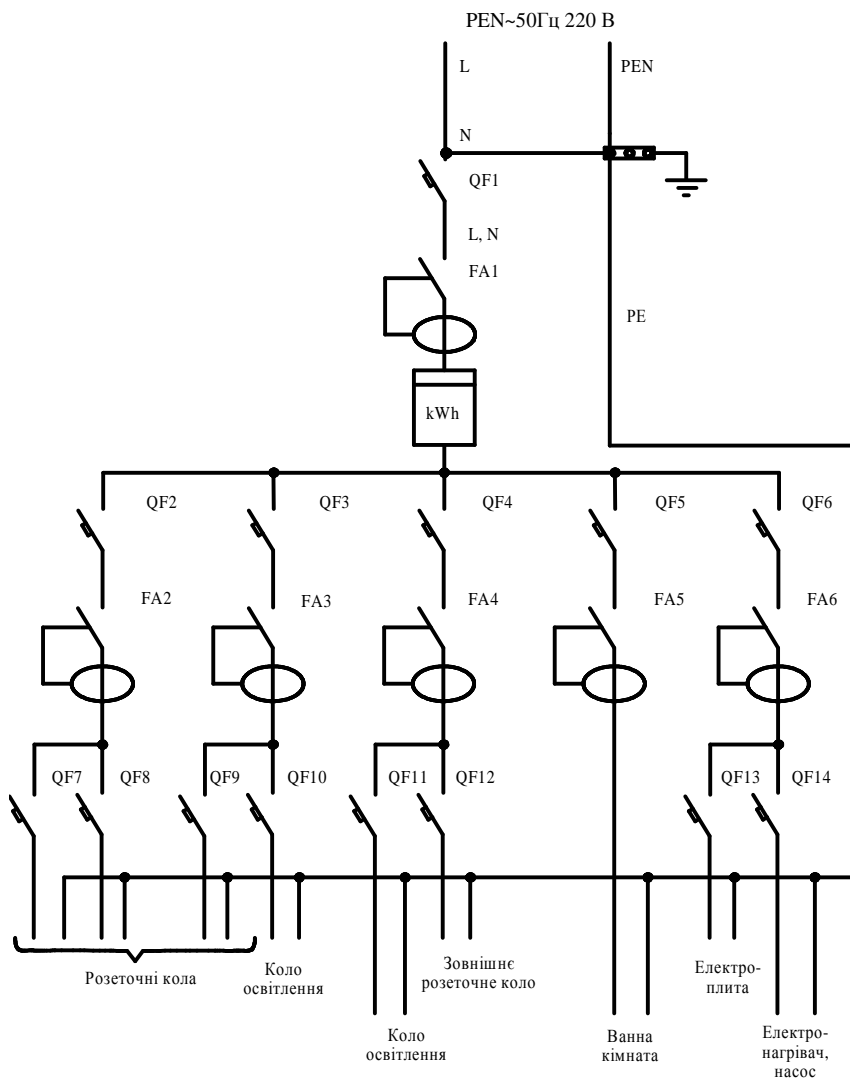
Схема електропостачання будівлі з системою TN-C-S
